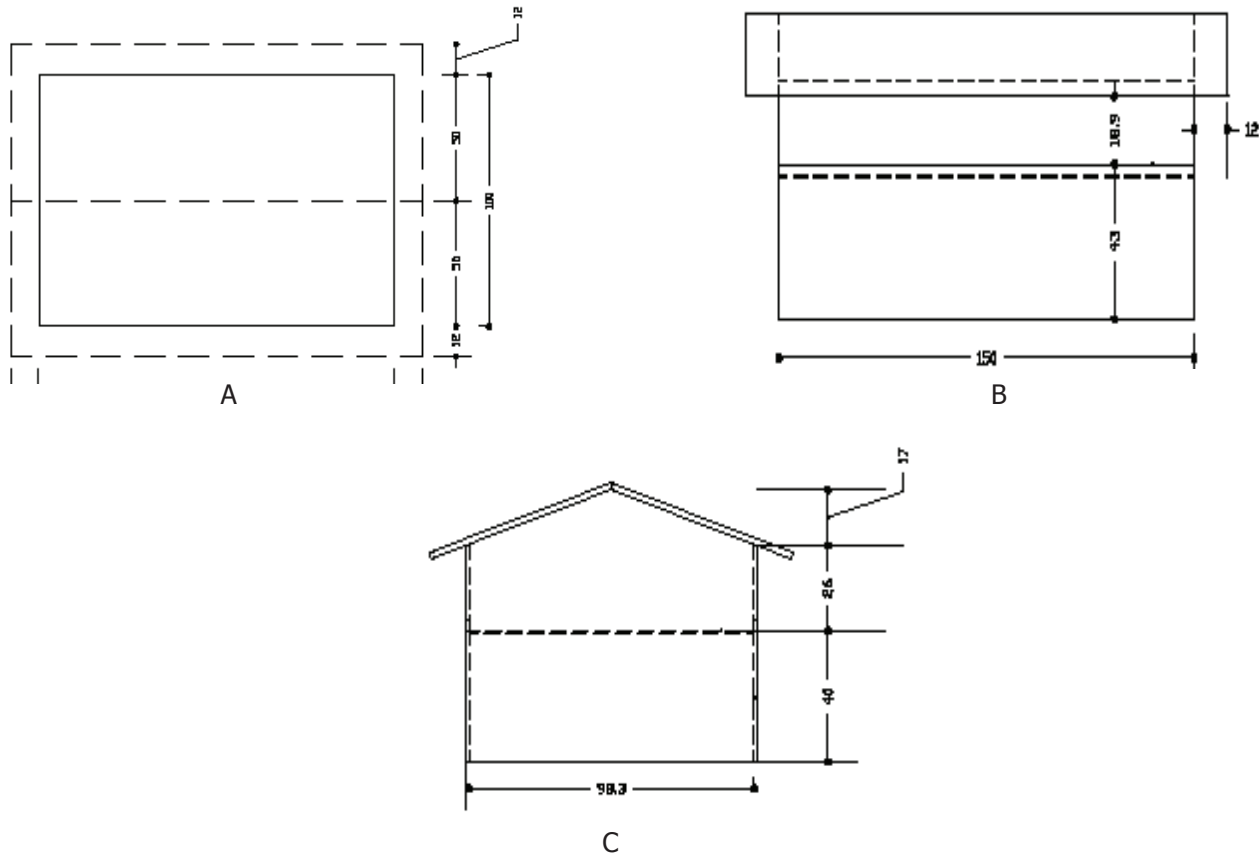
Dimensiones del modelo experimental utilizado para evaluar materiales empleados como cobertura de estructuras pecuarias A. Planta baja. B) Corte longitudinal. C) Corte transversal.
